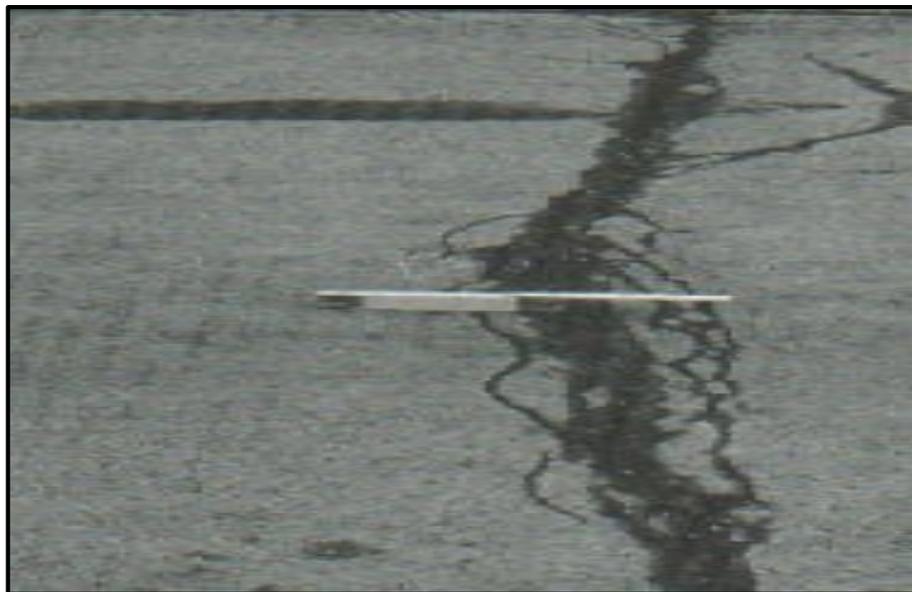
Patología por grieta de reflexión de junta.
